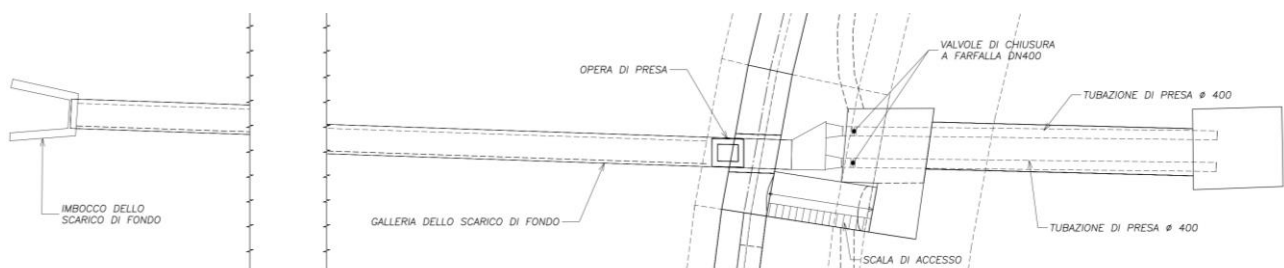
Planimetria dello scarico di fondo e opera di presa
